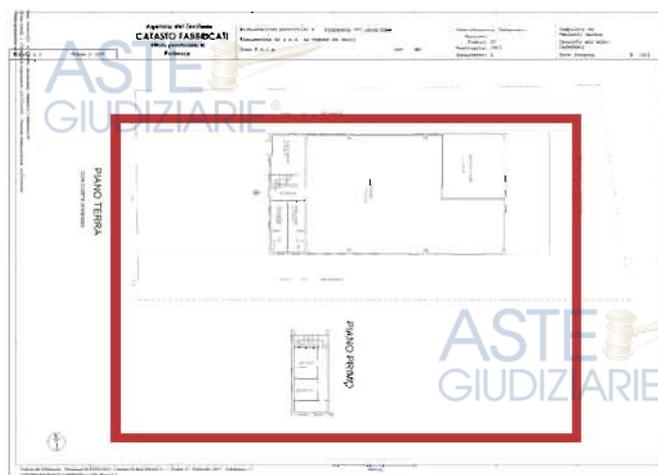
Raffronto stato reale con planimetria catastale Lotto L2 – Piano Primo (ALL. 05).
